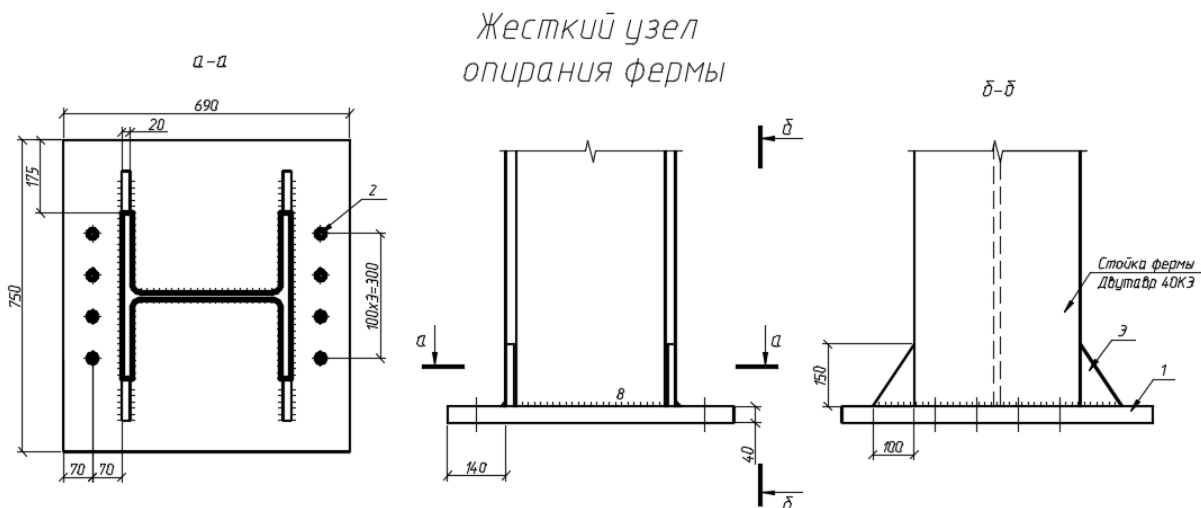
Жесткий узел сопряжения опорной стойки фермы с железобетонным поясом
